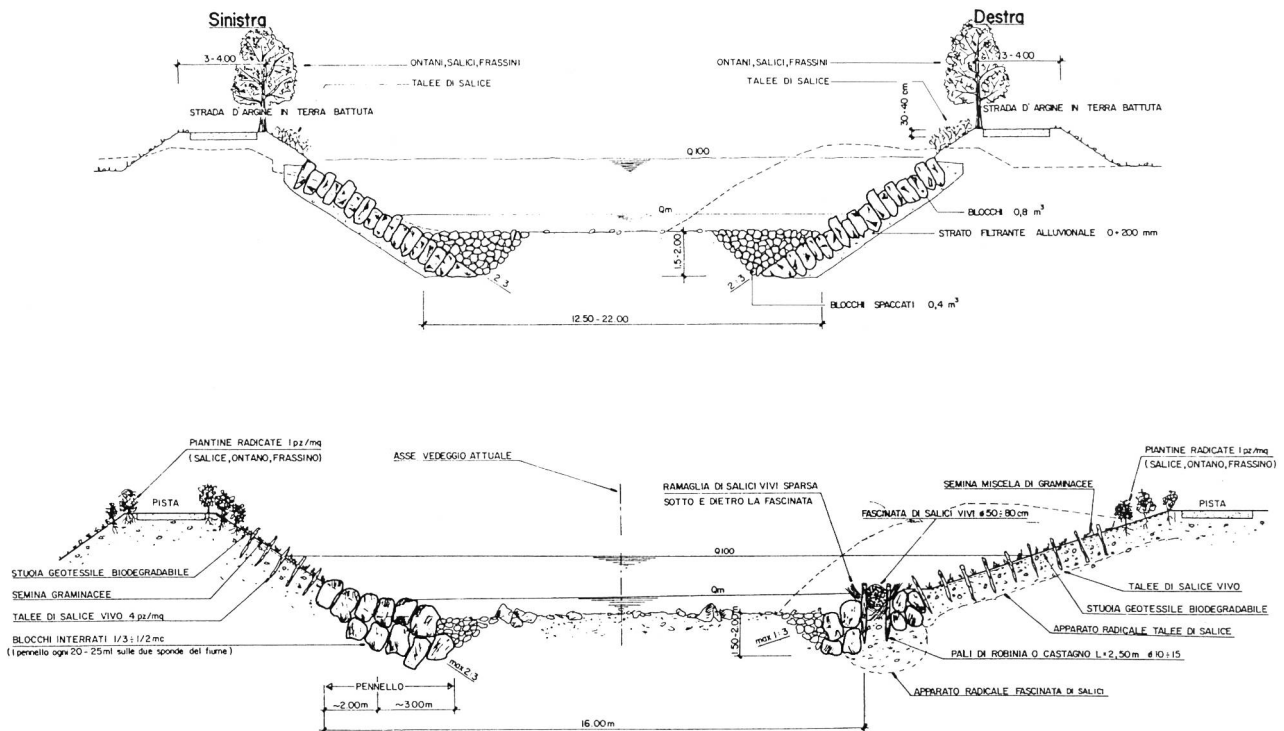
Sezioni tipo della parte bassa, con allargamento progettato. Figure 4. Sections-type sur le tronçon aval avec profils élargis. Bild 4. Querschnitts-Typen der unteren Strecke mit der geplanten Flussaufweitung.
